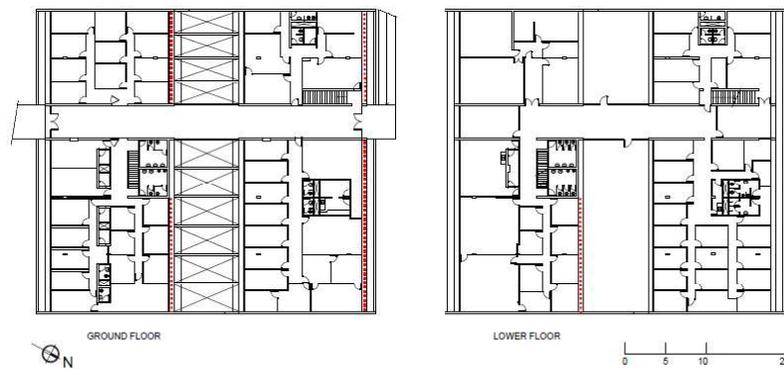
Planta baixa FE3 pavimento Térreo e Inferior. Fonte: Prefeitura do *campus* (adaptado por Christine Lucas).
